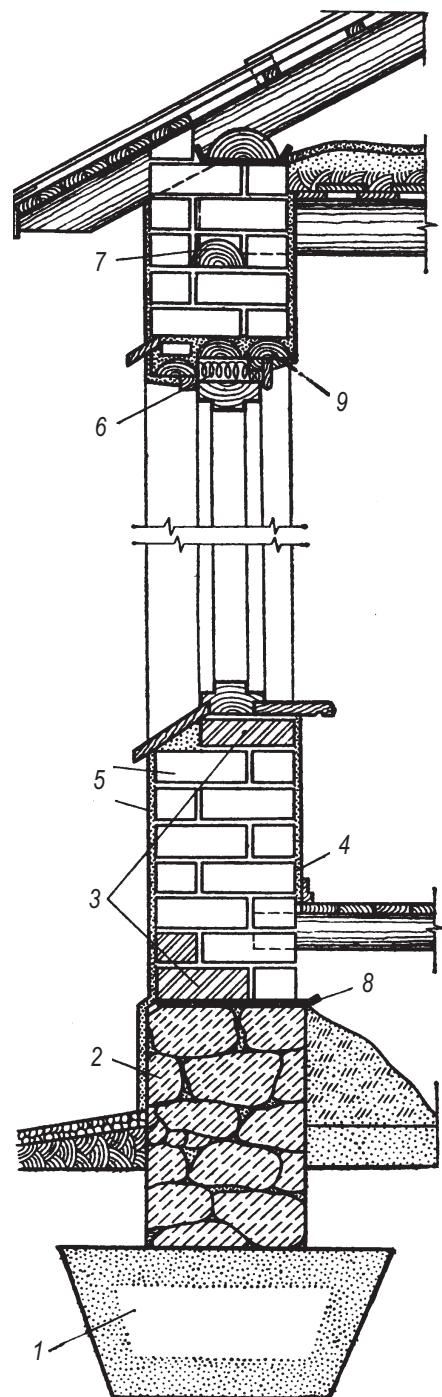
Розріз стіни з саману або ґрунтоблоків:
